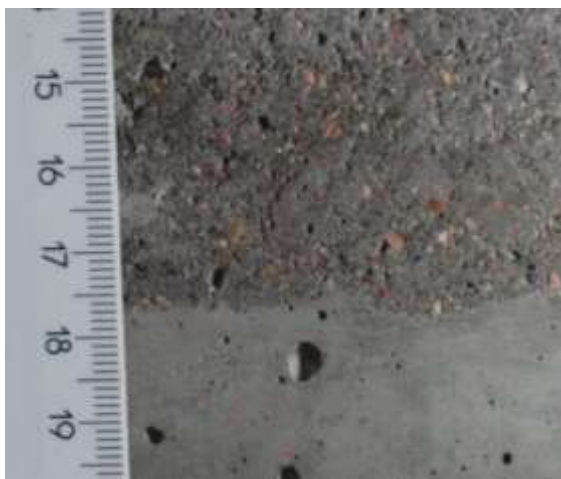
Beton C 40/50, otryskaný povrch betonu, tlak 130 MPa, měřítko v cm
